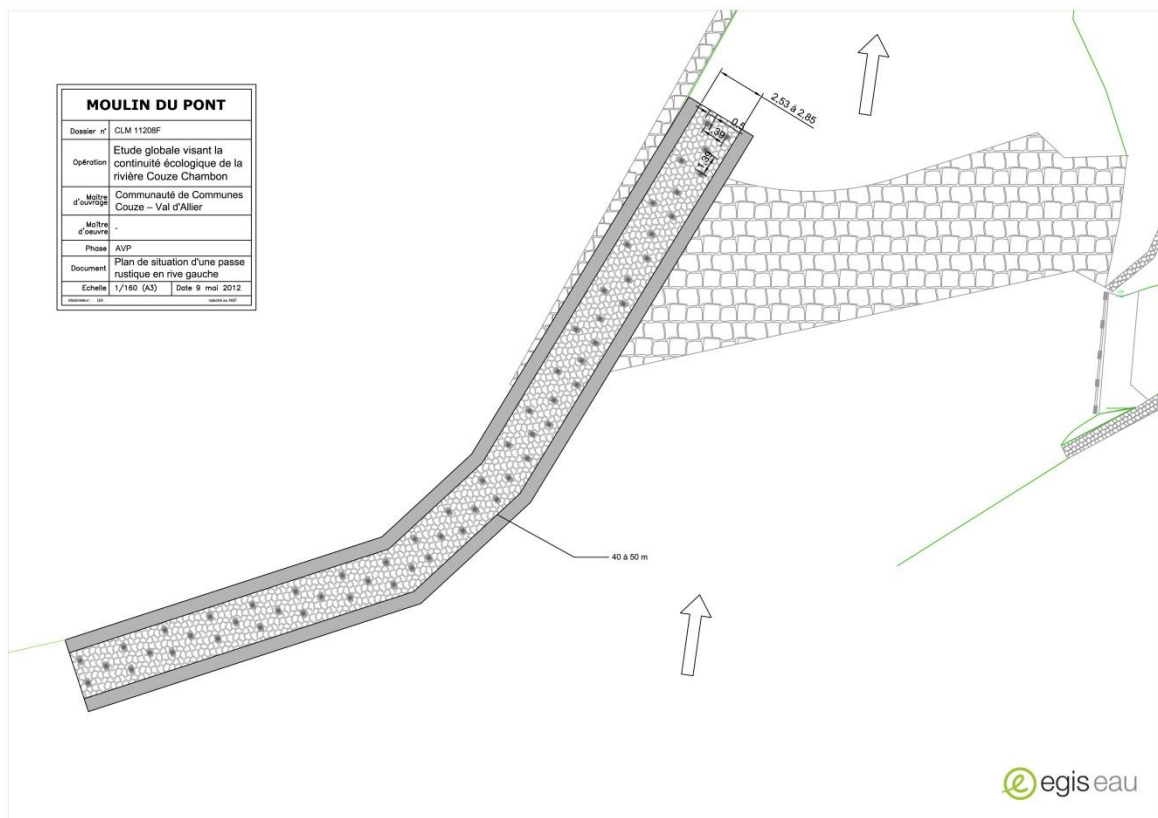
plan de situation d'une passe rustique en rive gauche (réalisation : G. Reix)
